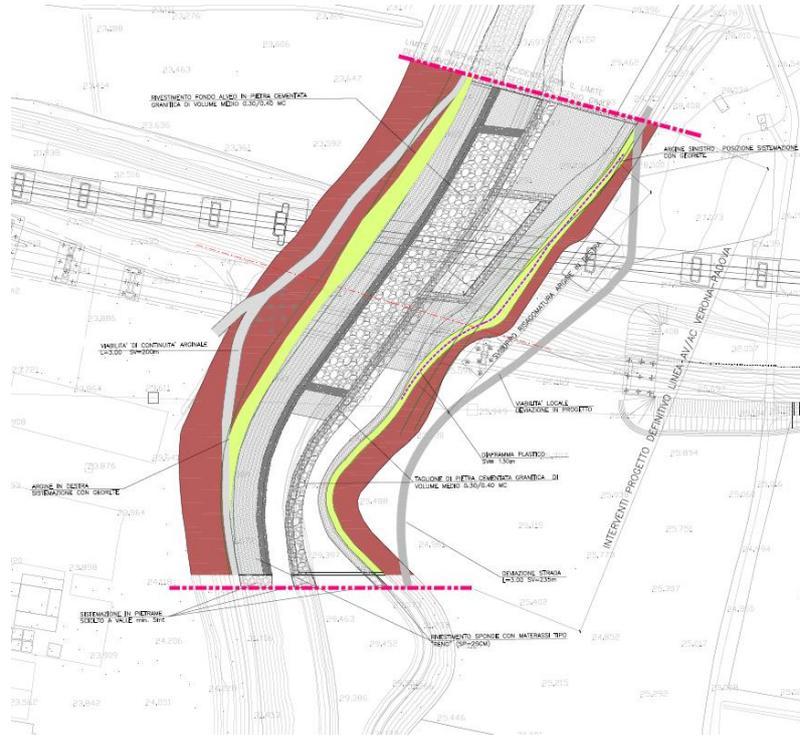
Planimetria post operam (rivestimenti di sponda estratti dal PD)
